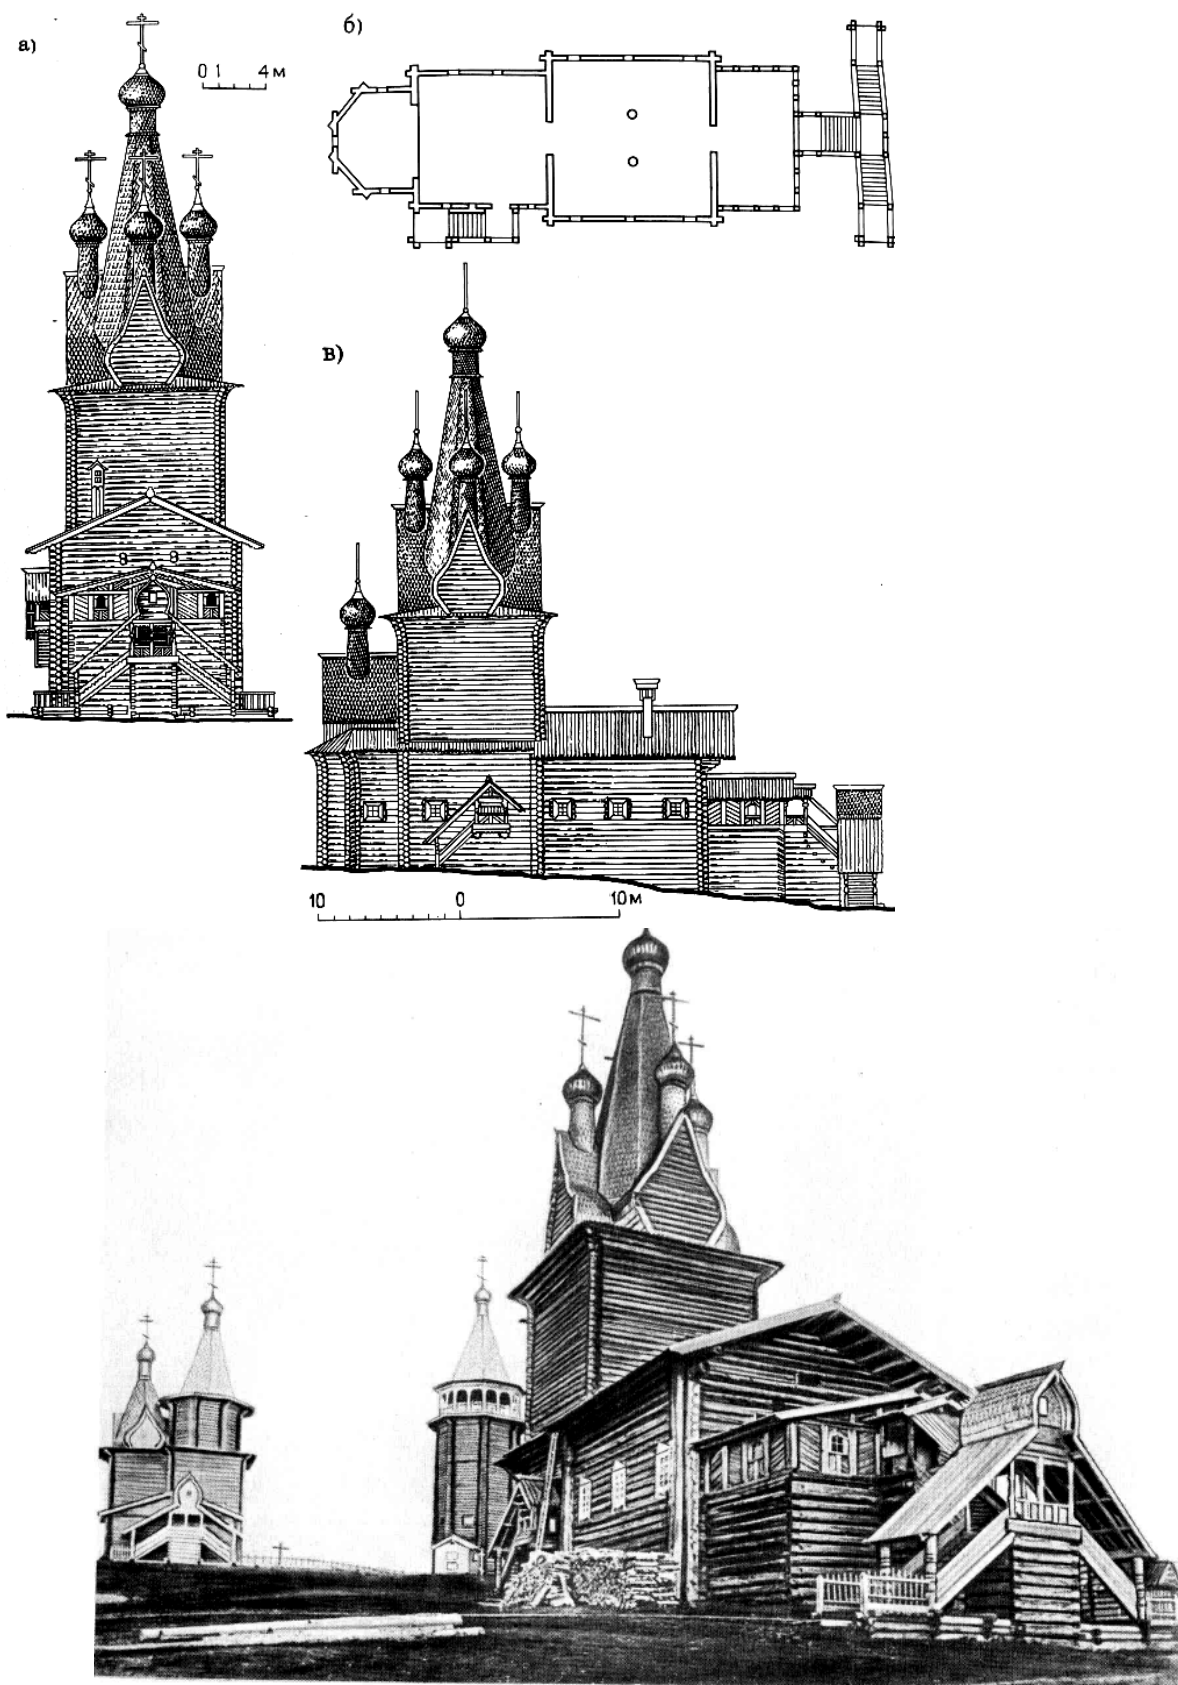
Церковь Михаила Архангела в с.Юрома, 1686 План, фасады, общий вид..
